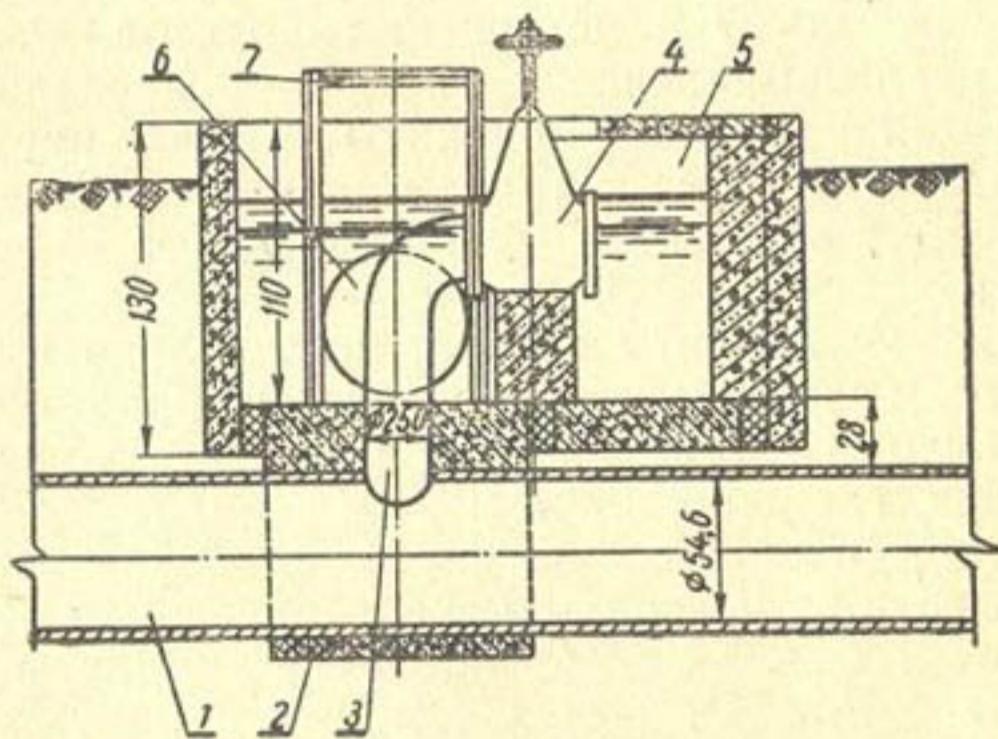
Открытый гидрант-водовыпуск на расход 220 л/сек:
